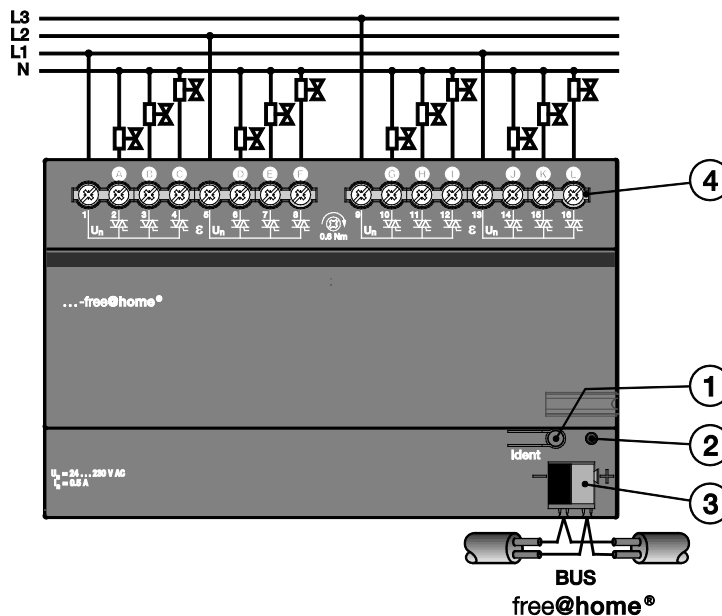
Vue d'ensemble de l'actionneur de chauffage 12x
